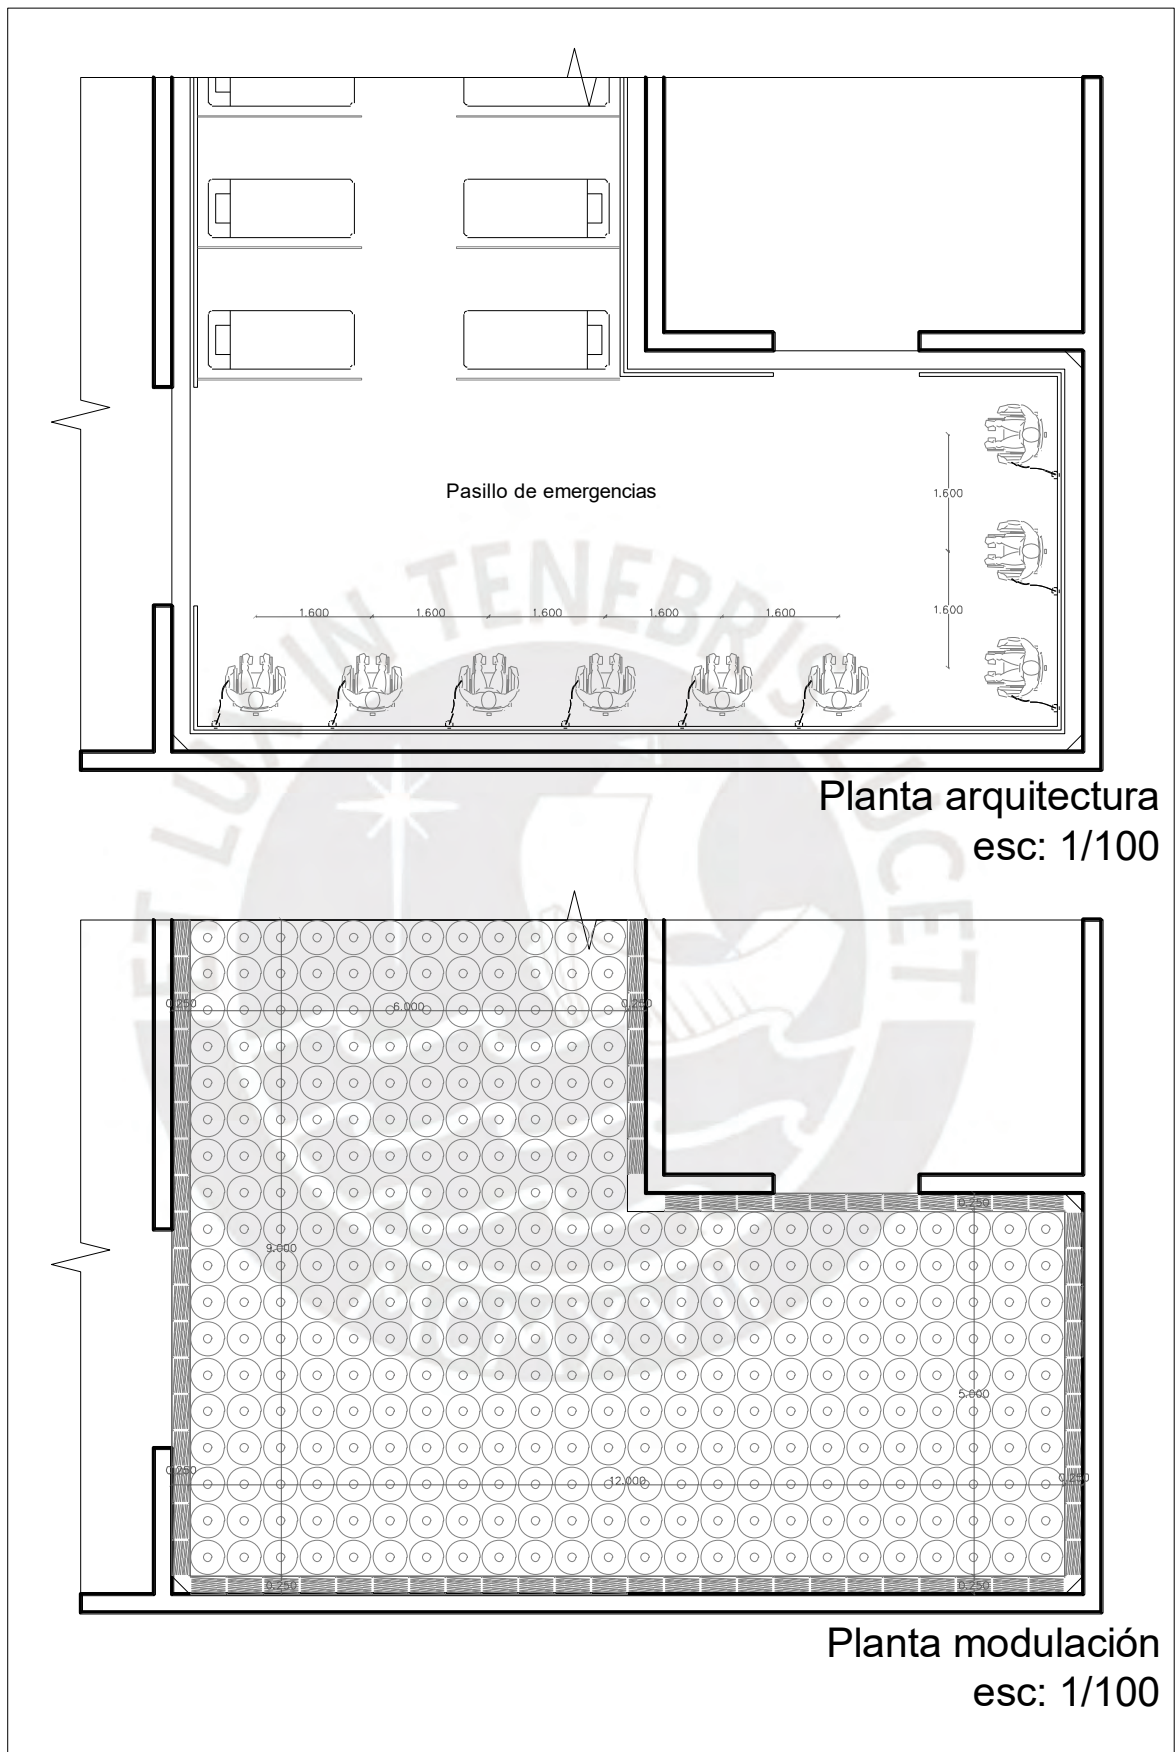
9: Planta de una habitación sobre la plataforma de aislamiento
